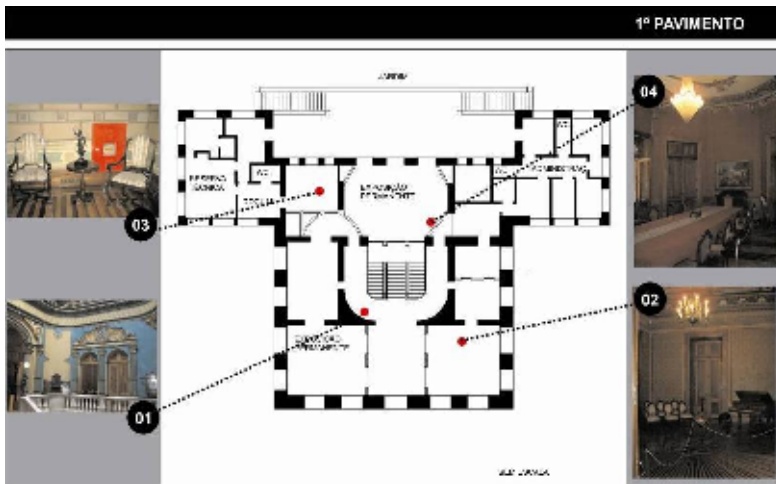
Primeiro pavimento. Fonte: Autora (2009).
